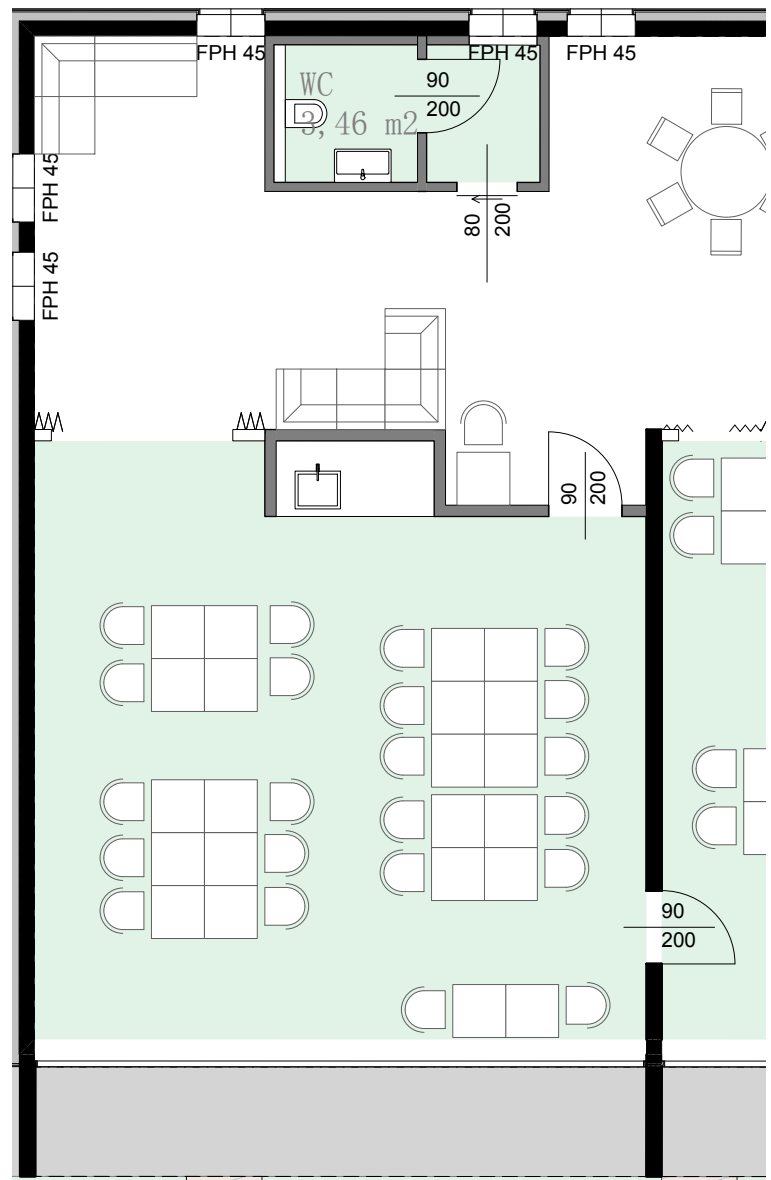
Ausschnitt Grundriss Erdgeschoss Maßstab 1:100
